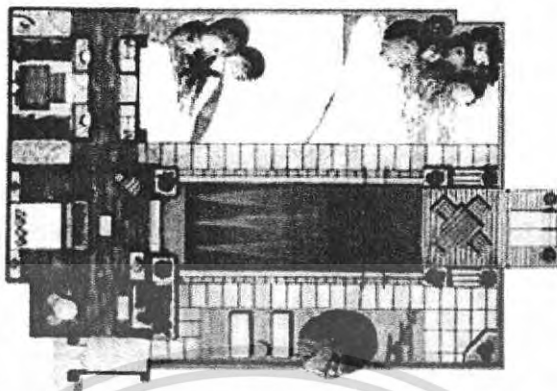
Layout plan ของห้องพักผ่อน Spa Pool Villa
